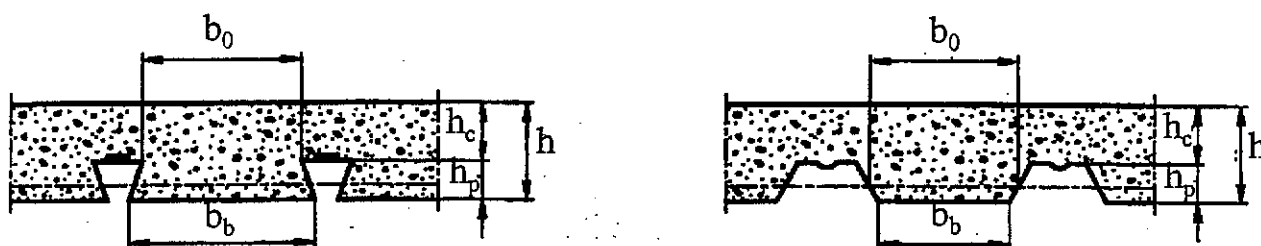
Dimensioni di lamiera e soletta
